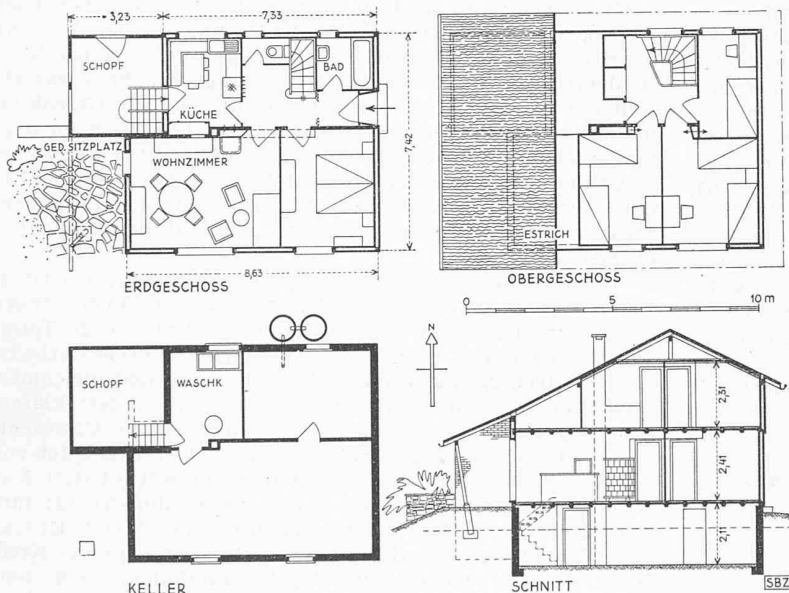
Grundrisse und Schnitt zu Bild 8, Masstab 1 : 250
